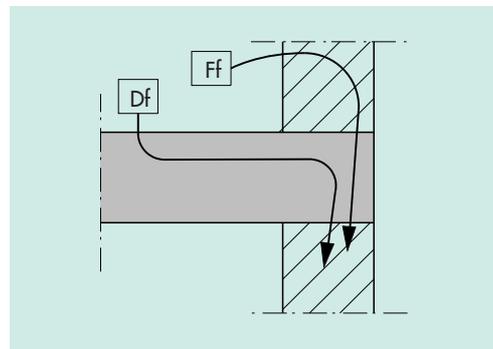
Voies de transmission du bruit à la jonction entre un plancher et des parois verticales.
